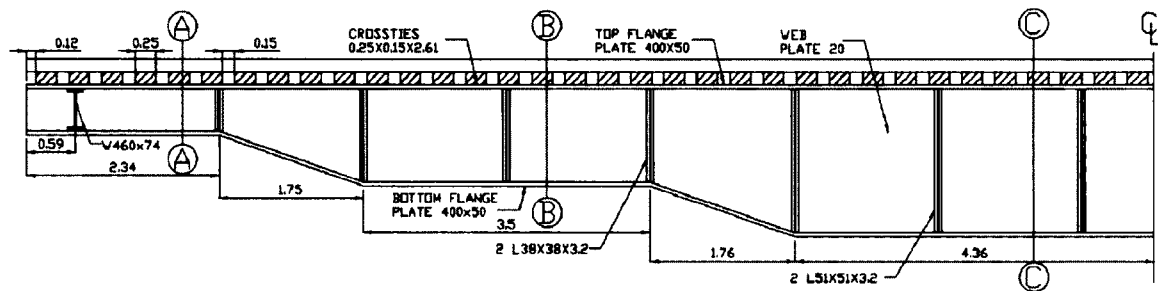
Pont à 4 poutres (27,432m) - Élévation
